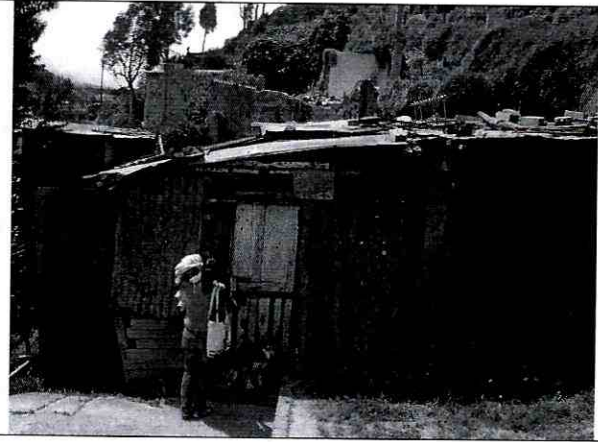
Vista frontal de la edificación emplazada en la Carrera 2 B No. 41-82 Sur en el Segundo Sector del Barrio Malvinas.
